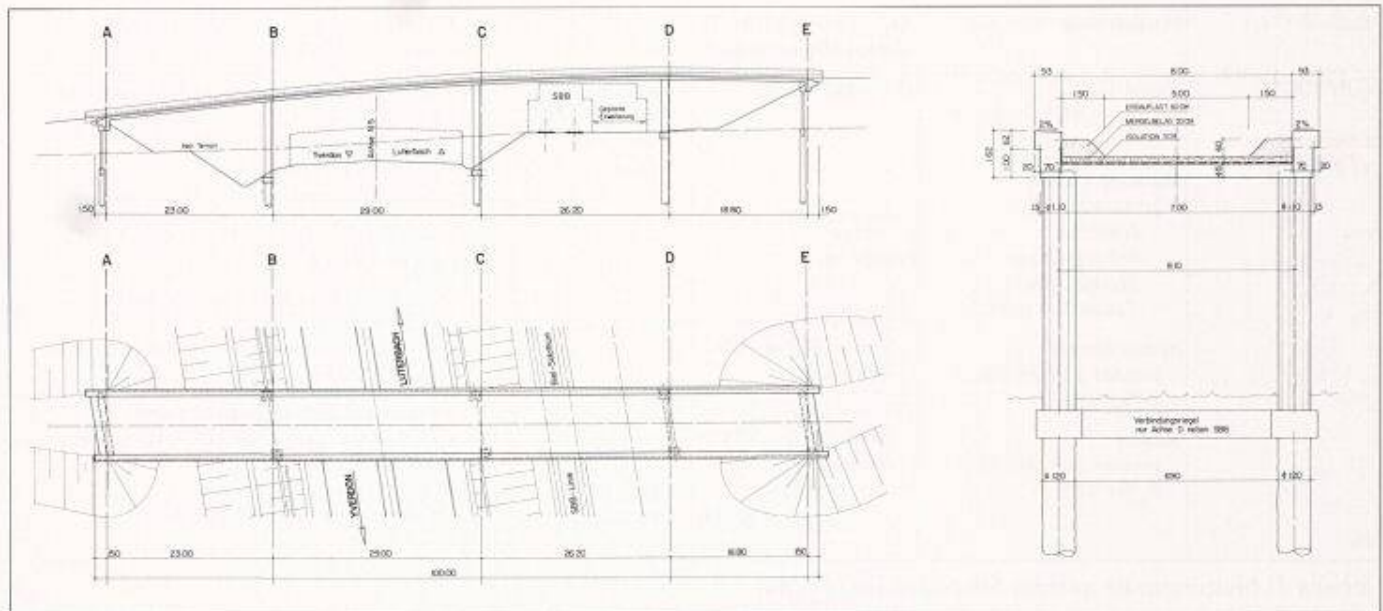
Objekt BS 12: Grundriss, Längsschnitt und Querschnitt
